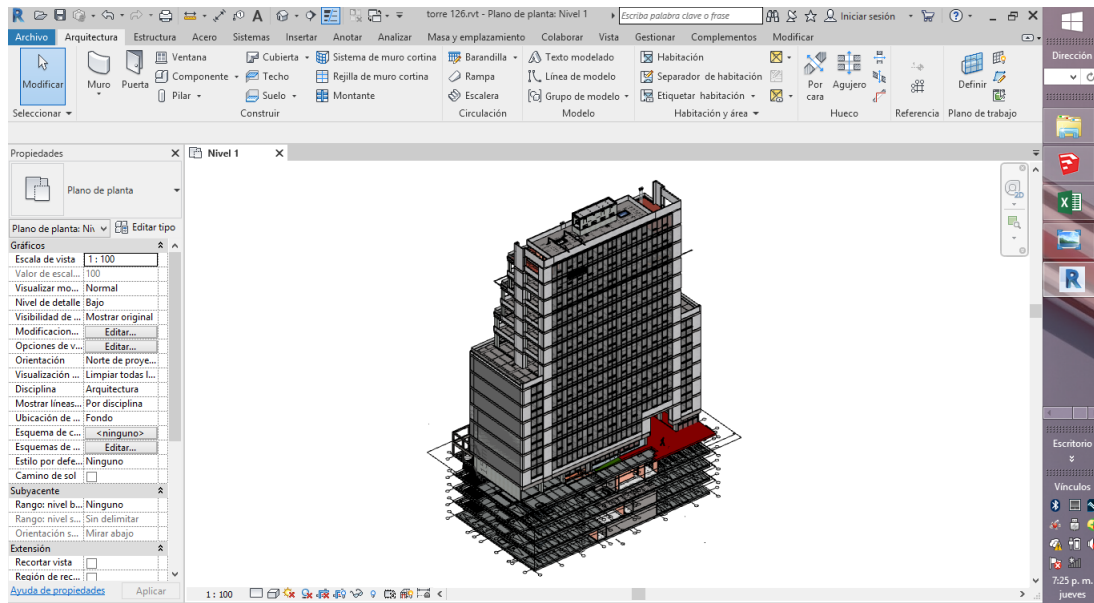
Modelado Arquitectónico y Estructural Revit, elaborado por: Andrés Pinzón
